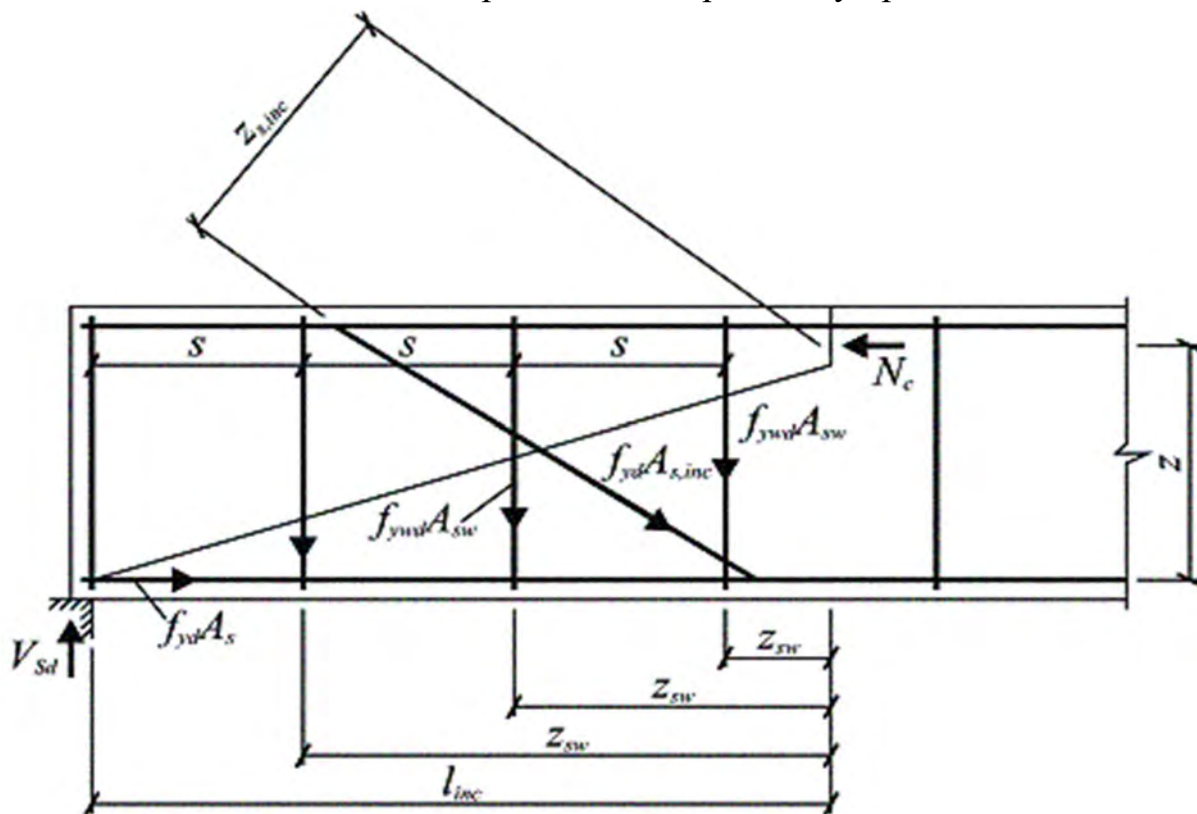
Схема усилий в сечении, наклонном к продольной оси железобетонного элемента, при расчете его по прочности на действие изгибающего момента.
